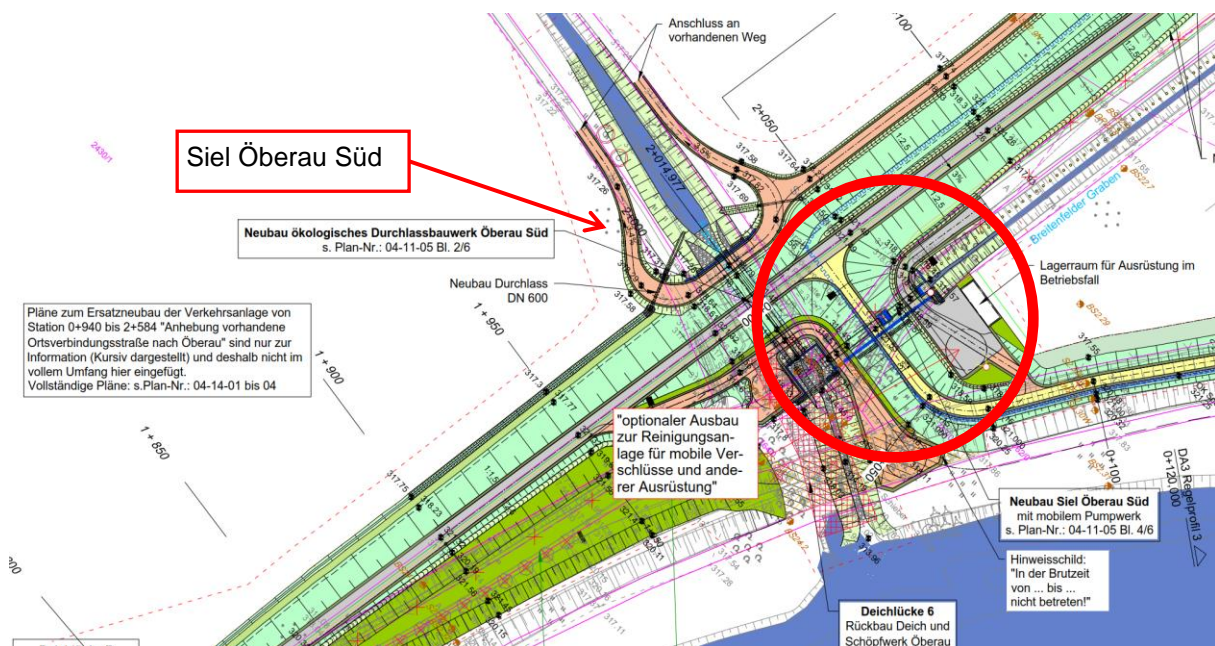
Siel Öberau Süd, Lageplan (aus Plan 03-03-03, Blatt 2/3)
